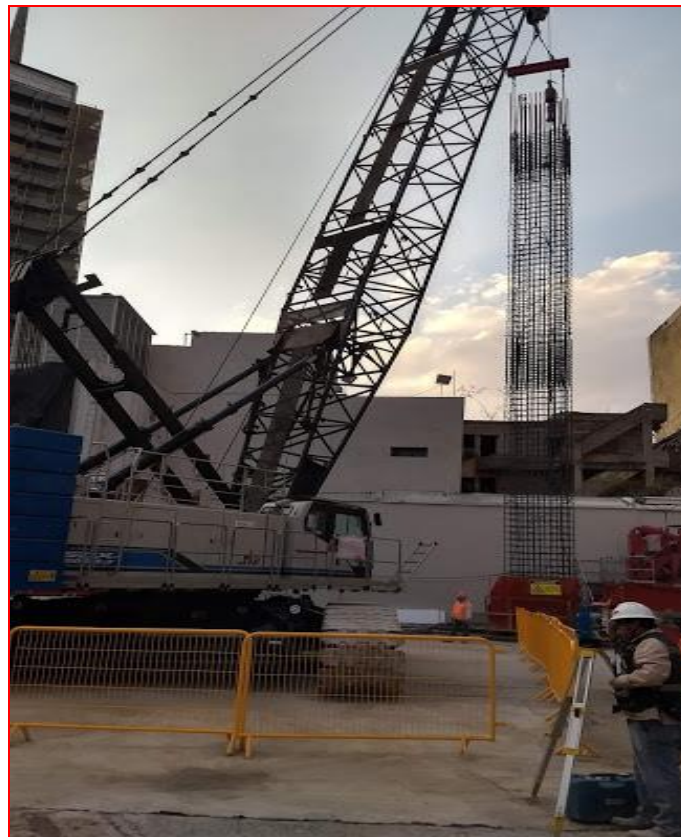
Armado de muro Milán suspendido en el sitio de obra previo a introducirlo en la lumbrera. (CIMESA 2019).
